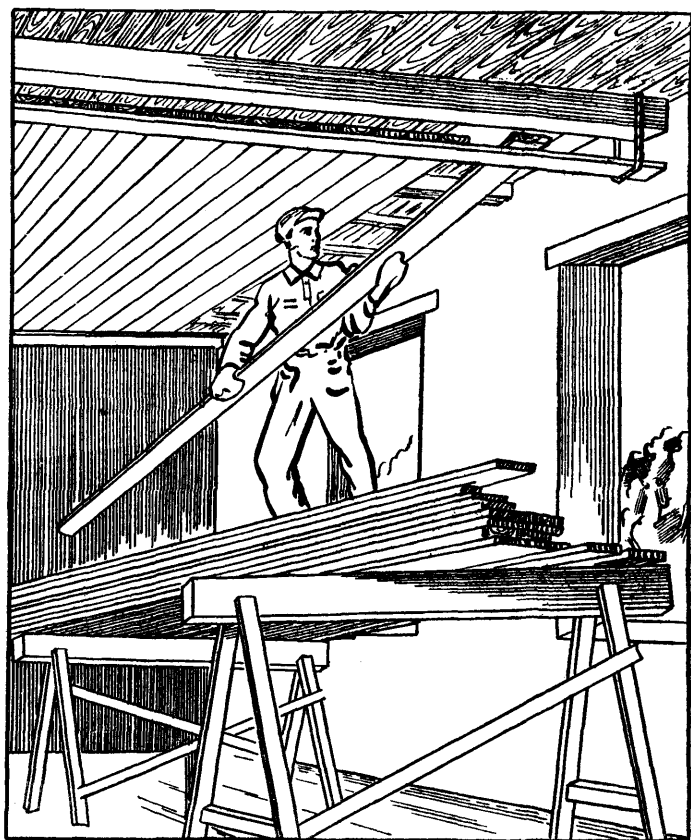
Подшивка потолков с помощью приспособления Сычева.
